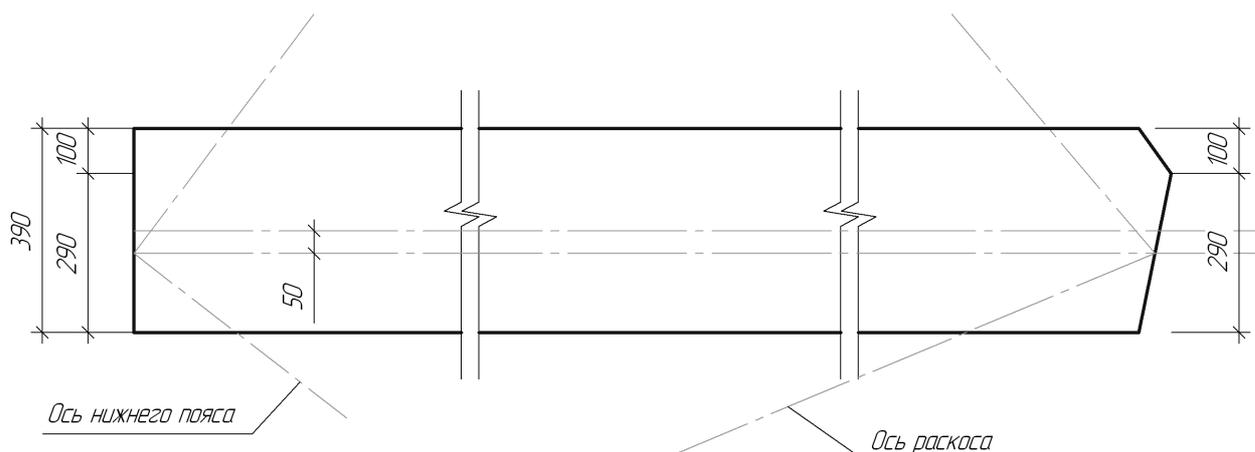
Определение эксцентриситетов ($e_1; e_2; e_3$) продольного усилия в верхнем поясе.
